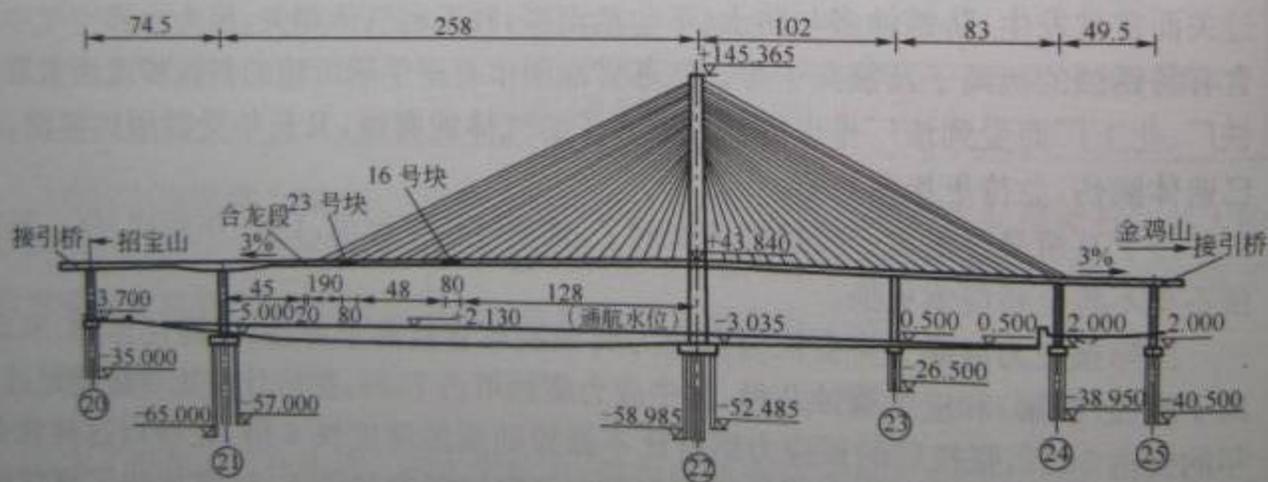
某预应力混凝土大桥(尺寸单位:m)
